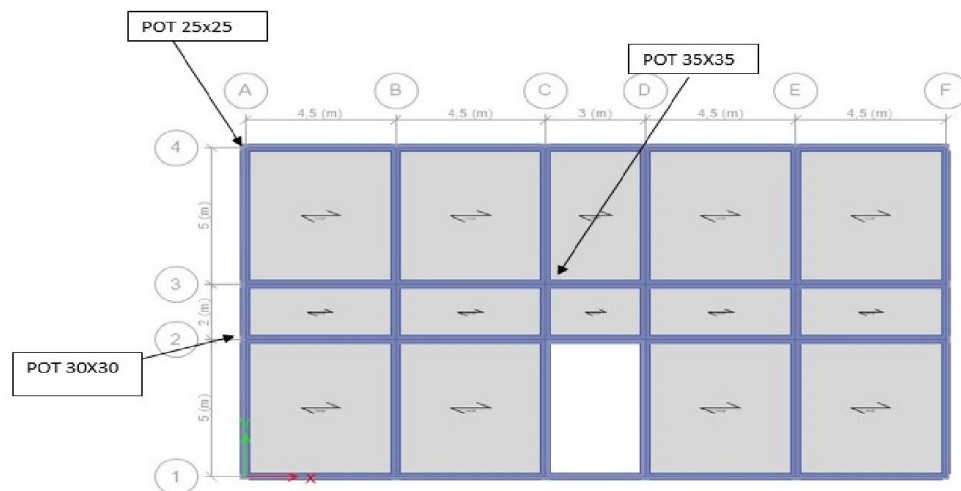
Vue en plan (représentation de différentes dimensions de poteaux)
